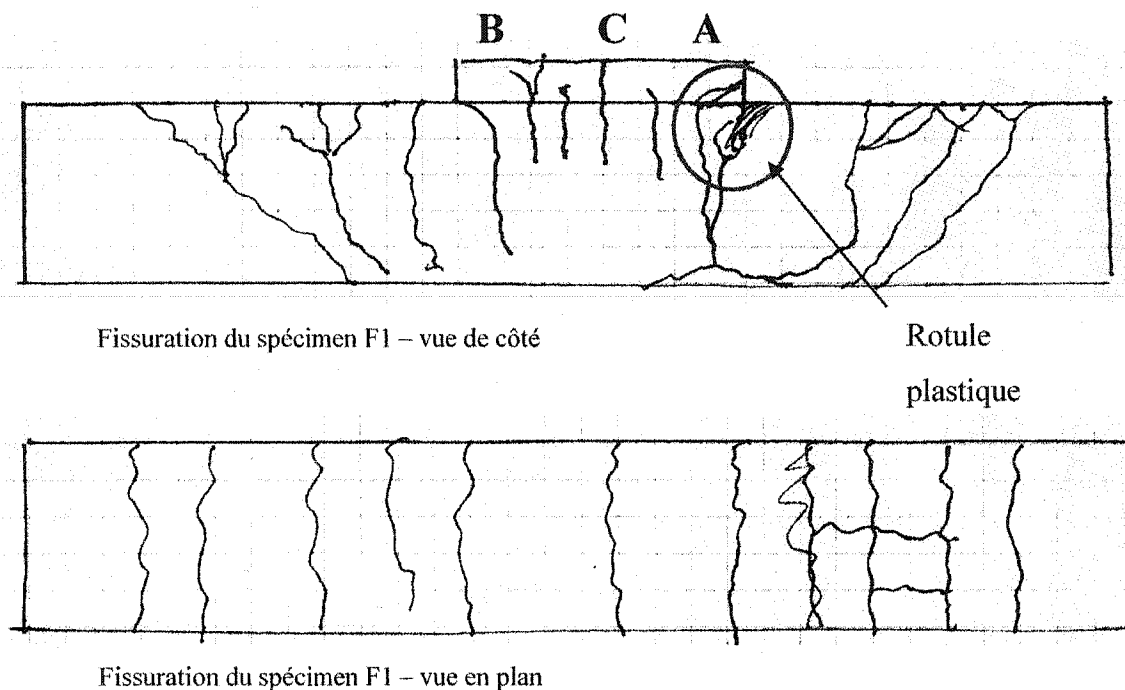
Patron de fissuration du spécimen F1
